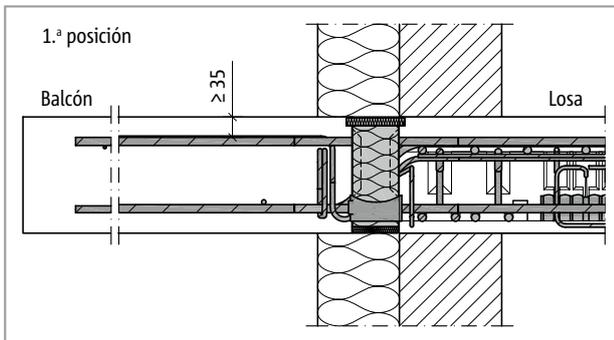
Schöck Isokorb® T tipo C: Sección 1.ª posición; conexión para sistema de aislamiento térmico exterior (SATE)
